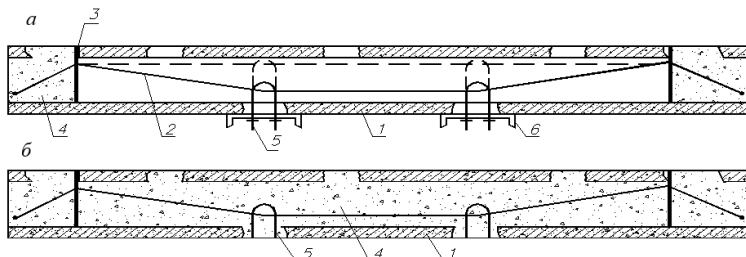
Вариант создания предварительного напряжения дополнительной арматуры при усилении сборных многопустотных плит: а – плита в момент предварительного напряжения арматуры; б – усиленная плита, 1 – усиливаемая плита, 2 – дополнительная арматура, 3 – временная ограничительная пластина, 4 – бетон, 5 – натяжной болт, 6 – опалубка
